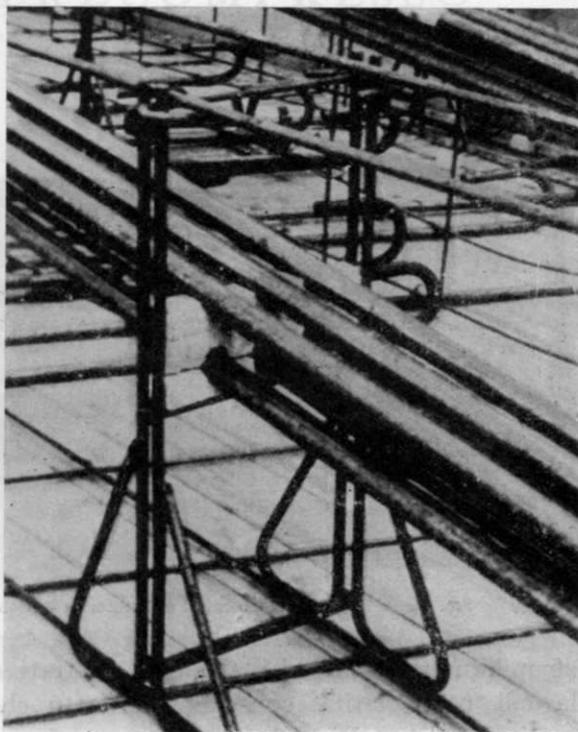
Cavalletto di appoggio per gli elementi di trazione.
